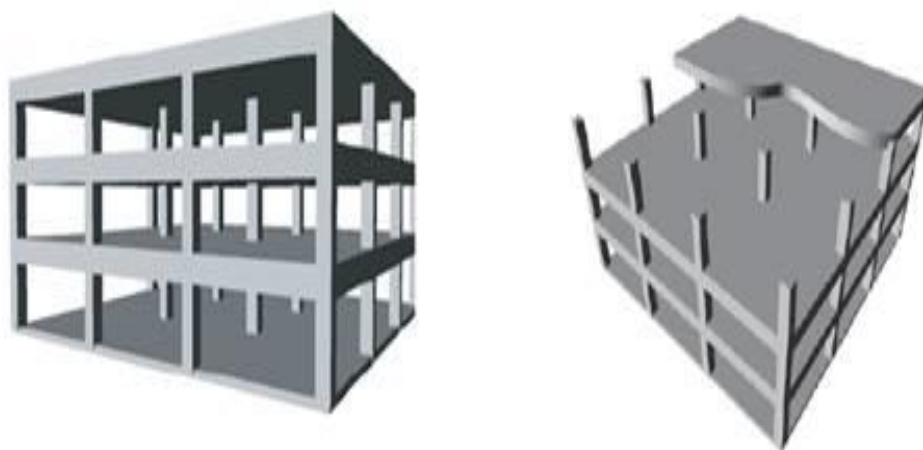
Ejemplo de Sistema Estructural Aporticado
